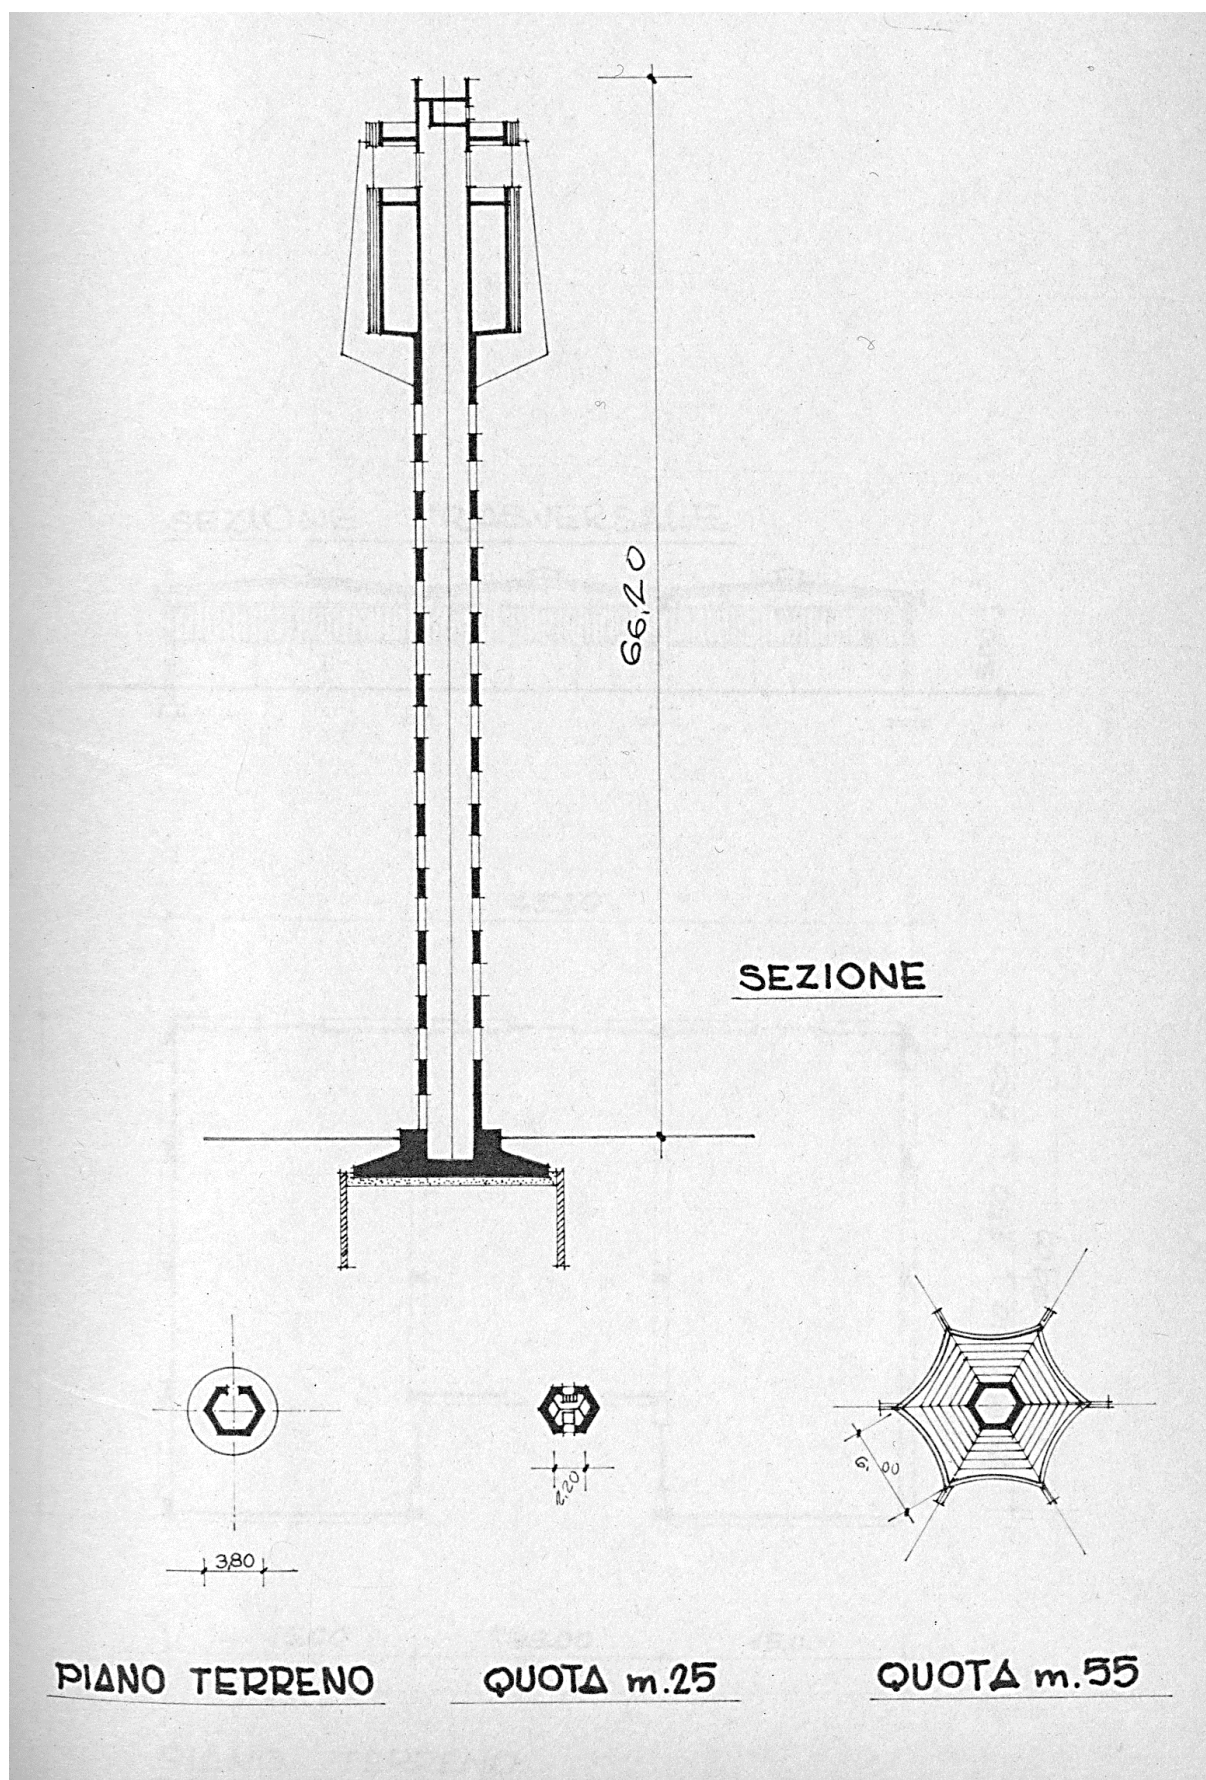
Disegno dell'Impianto generale redatto dall'Ingegnere Silvano Zorzi.
